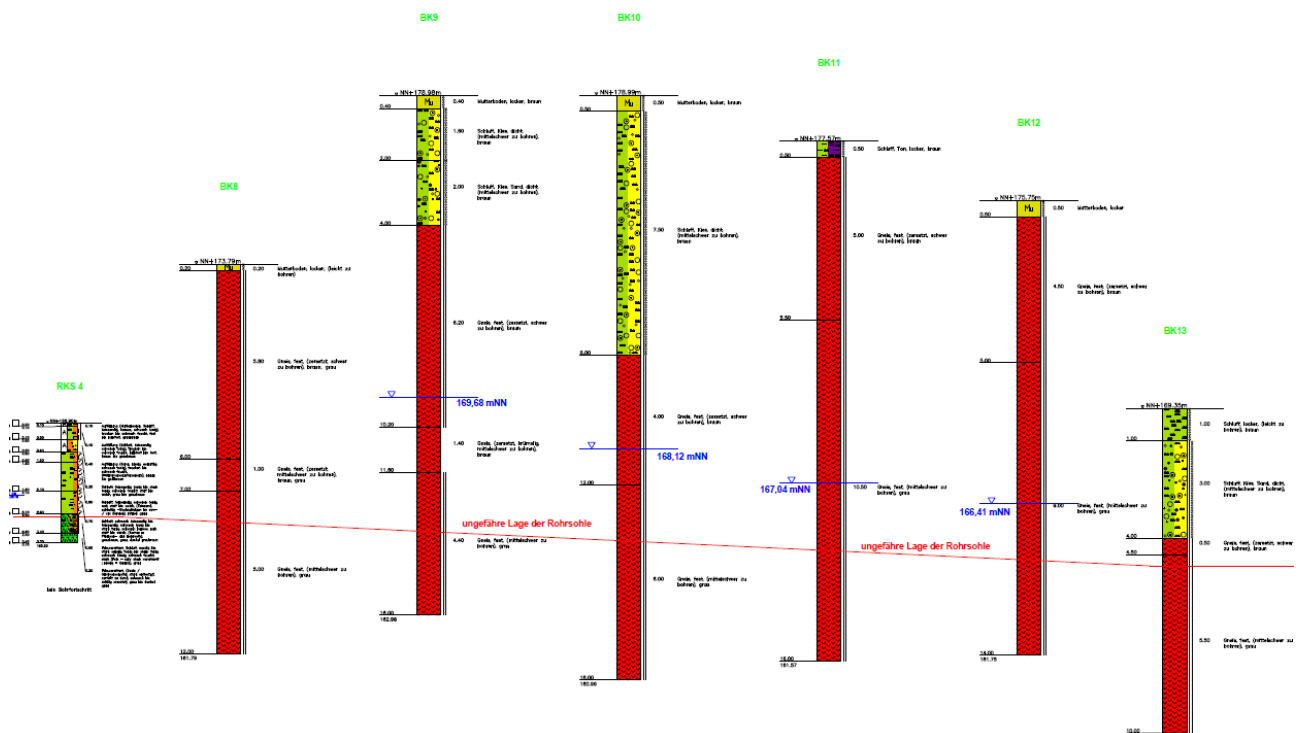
Baugrundschnitt mit projizierter Tunneltrasse
